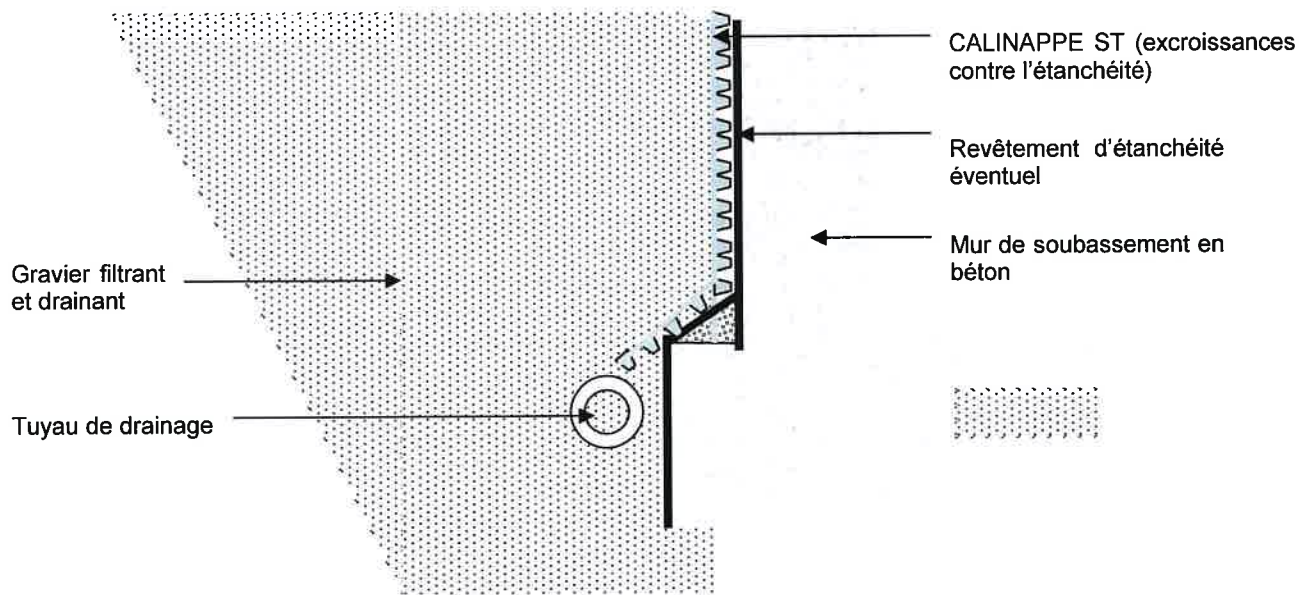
Schéma de principe de la nappe CALINAPPE ST (coupe verticale)
